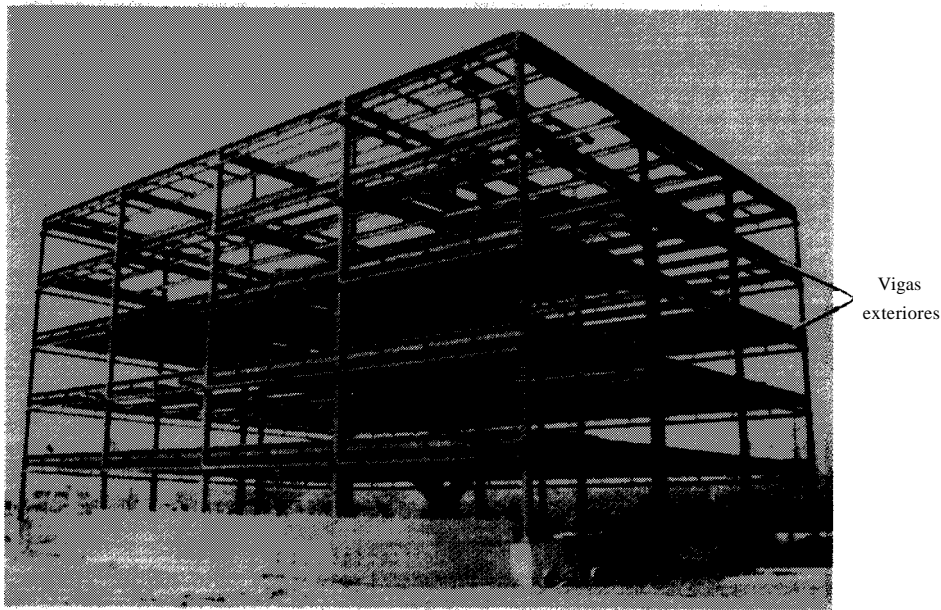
Vigas exteriores en un edificio de oficinas de cinco pisos. Nótese que las vigas exteriores soportan traveses más pequeñas y a las que se fijarán los muros de la fachada.
